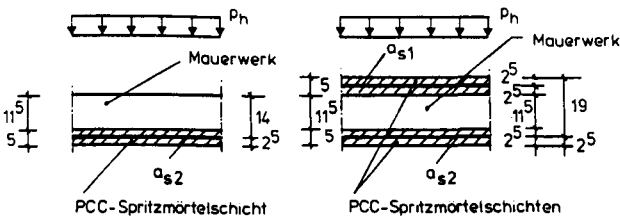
Horizontale Traglasten durch betonstahlbewehrte Ergänzungsschichten verstärkter, kreuzweise lastabtragender Mauerwerkswände: Variation des Bewehrungsgehaltes
